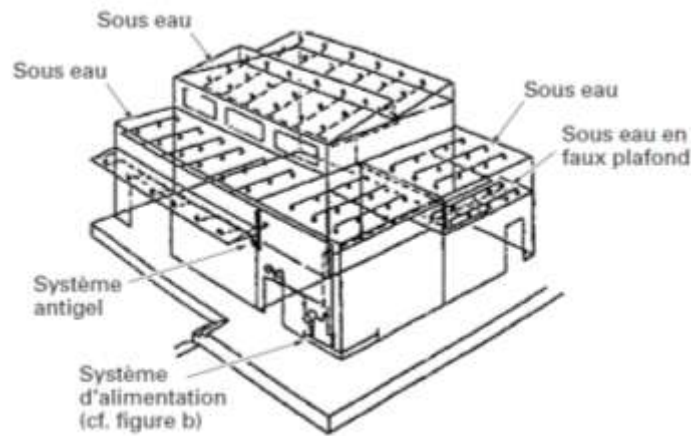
vue générale de l'installation sprinkler [HOO11].
